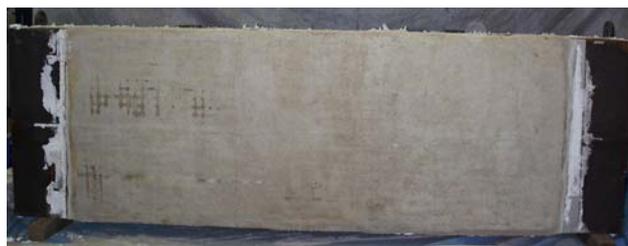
耐火被覆付コンクリート充填鋼殻試験体(CFSS1)加熱面状況
